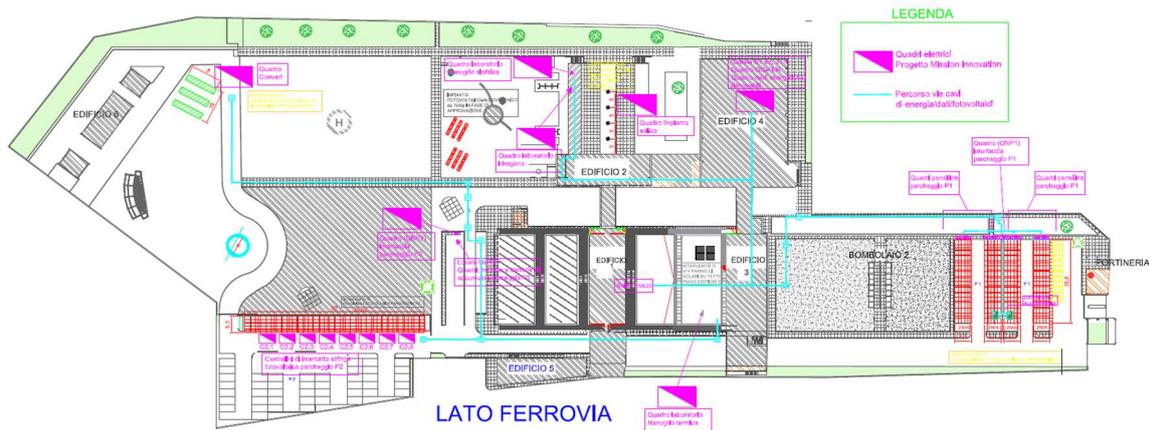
Indicazioni planimetriche dell'area dei lavori oggetto dell'appalto
